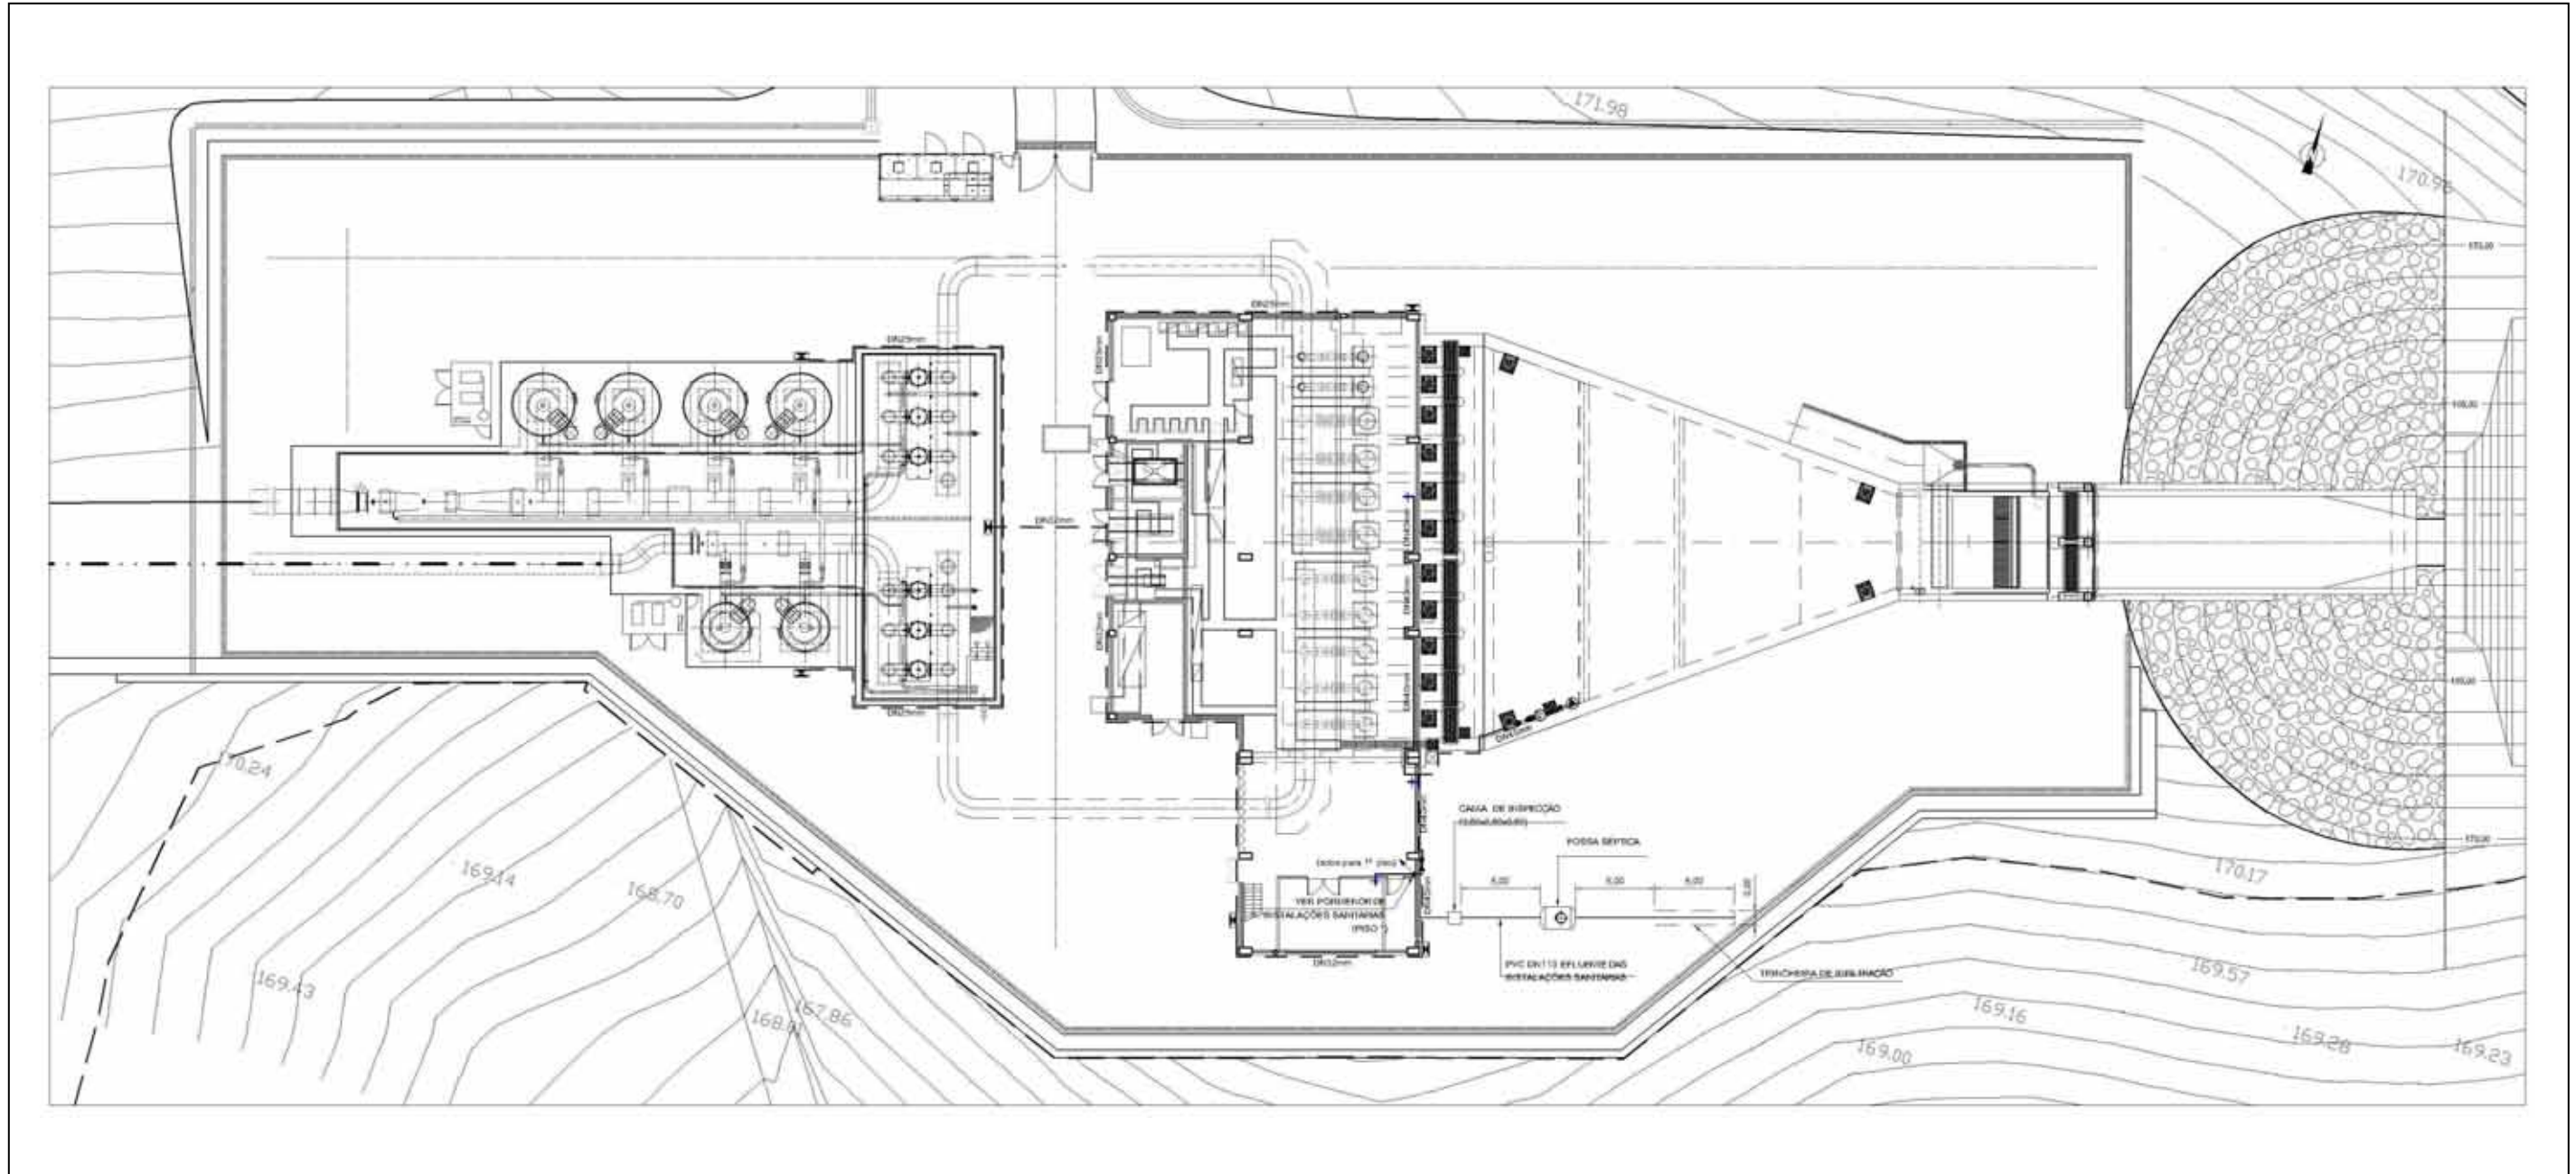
Planta de implantação da estação elevatória do Penedrão.
